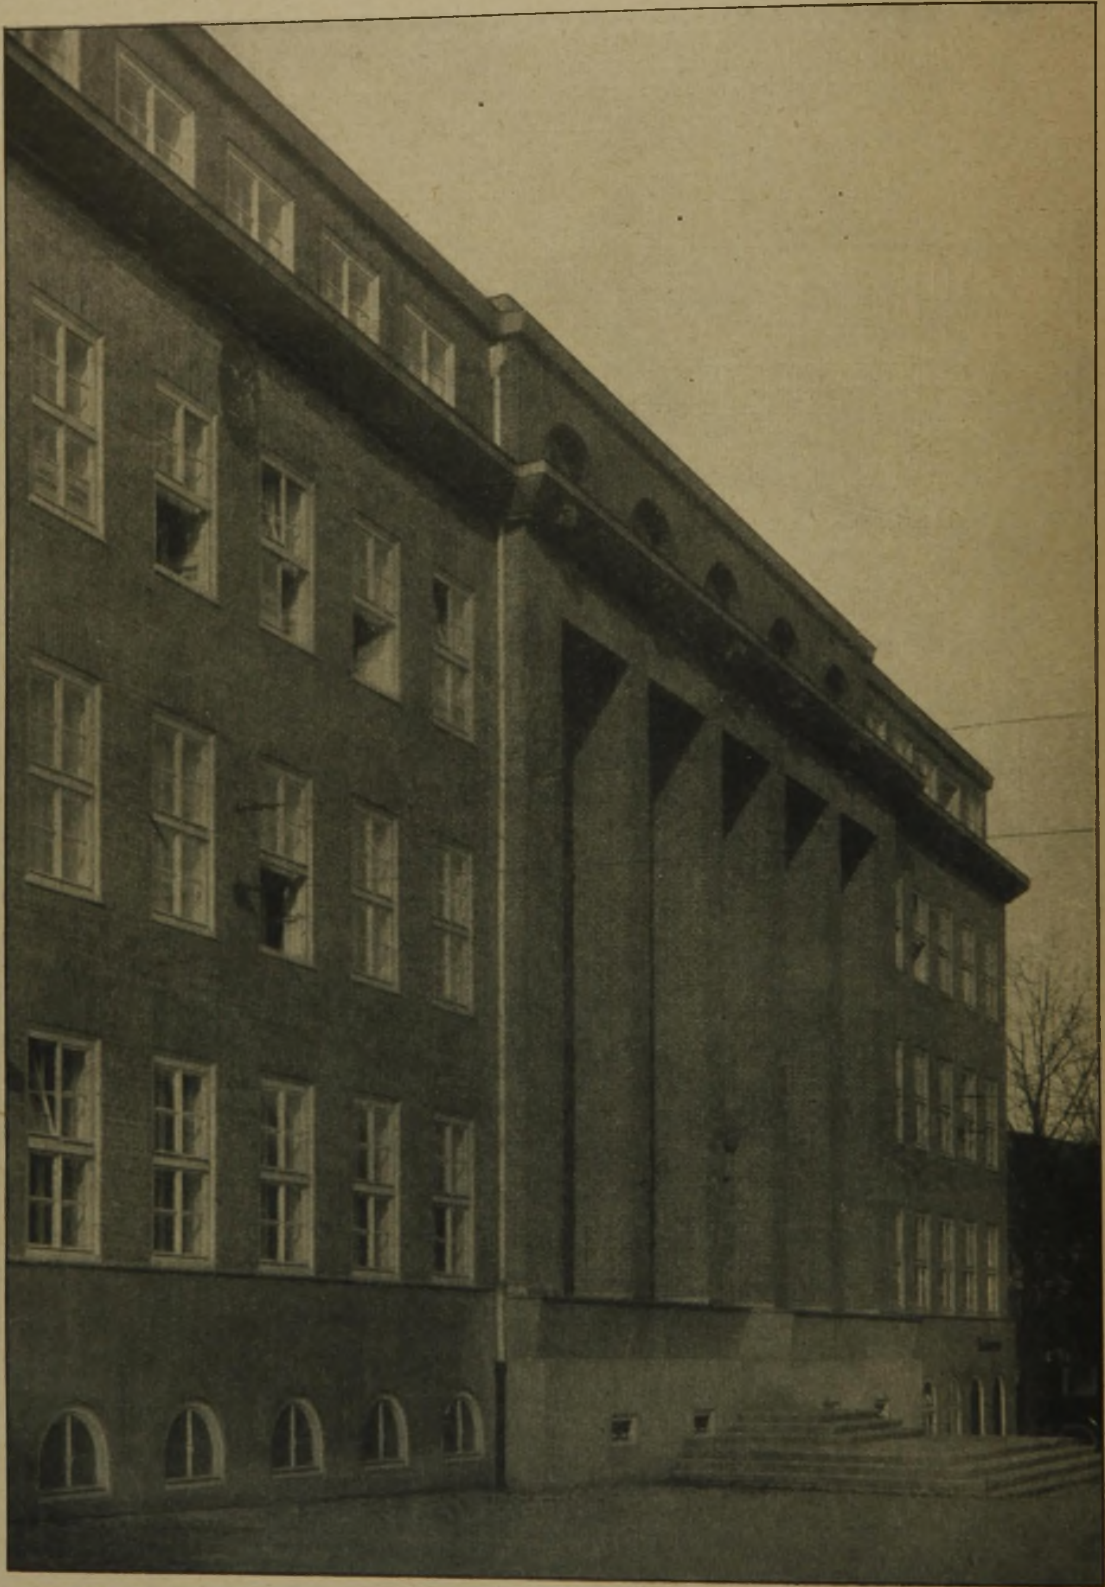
Hauptfassade mit Haupteingang an der Rüttenscheider Straße.
